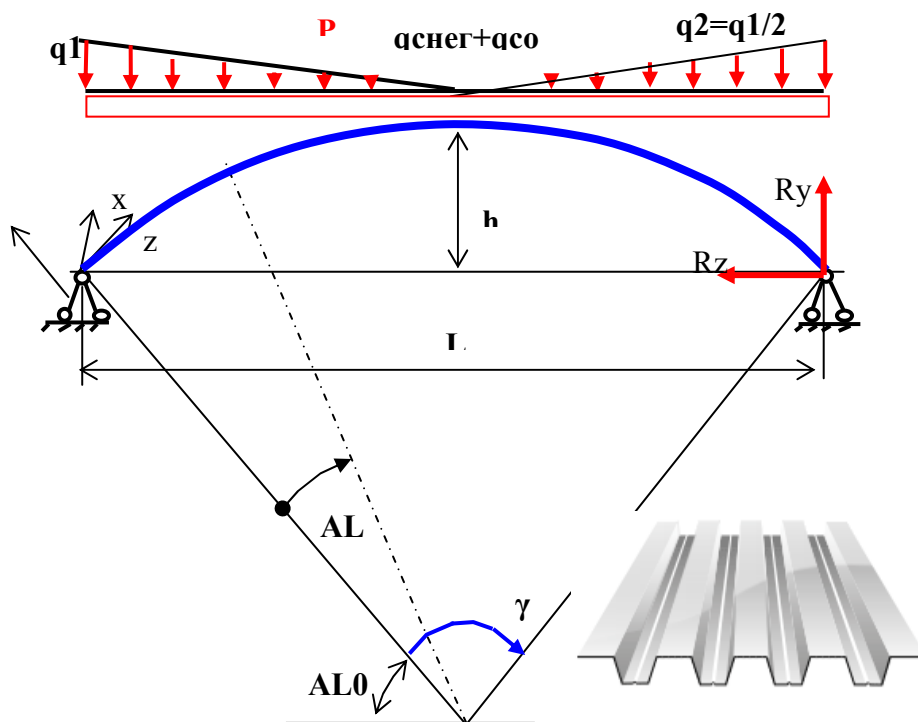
Основное сочетание нагрузок на арочное покрытие
